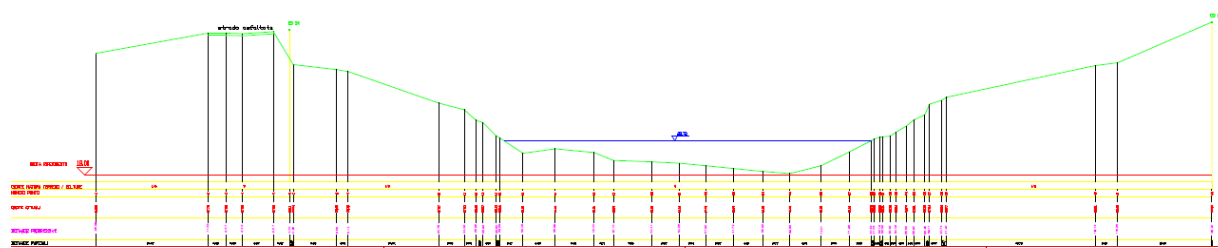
Sezione tipo a valle del ponte Artimino.
